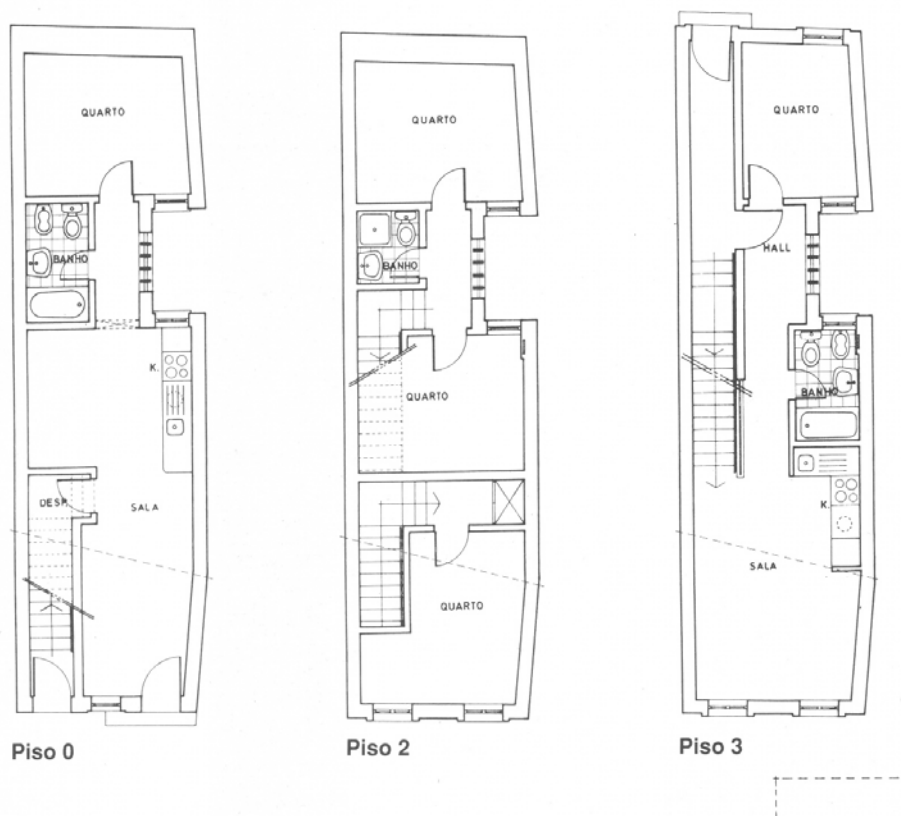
Exemplo de Reabilitação Especial – reconstrução – planta baixa (CABRITA, 1993, p. 202).
